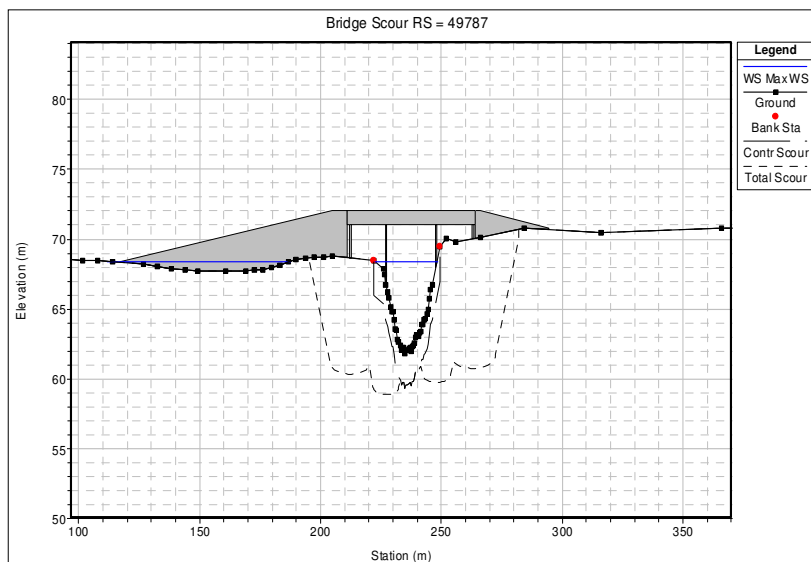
Puente en Piedra Grande - Perfil Transversal erosionado – d50: 1.00mm
